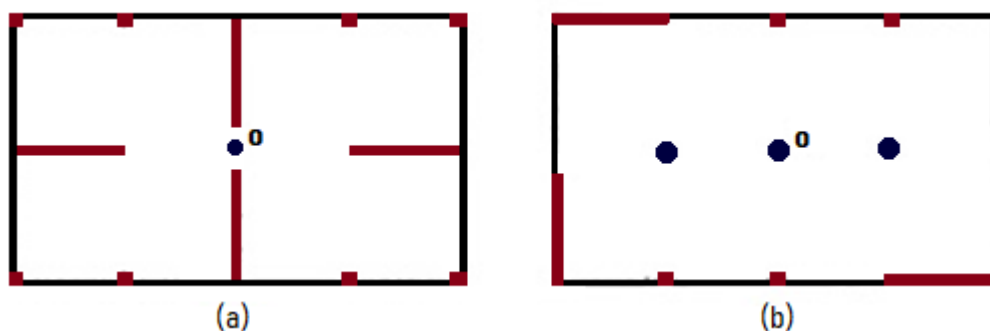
Assimetria em planta ou ações horizontais excêntricas: translações horizontais e rotação em torno da altura do edifício.
